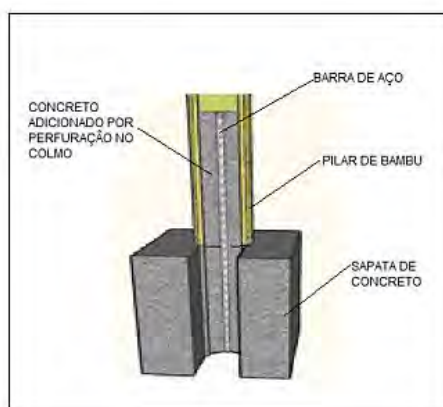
Sistema de apoio com incorporação do pilar a sapata de concreto.
